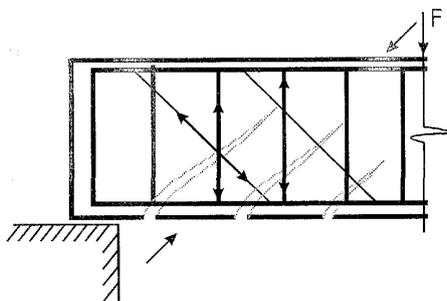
К расчету прочности бетона по наклонной сжатой полосе
